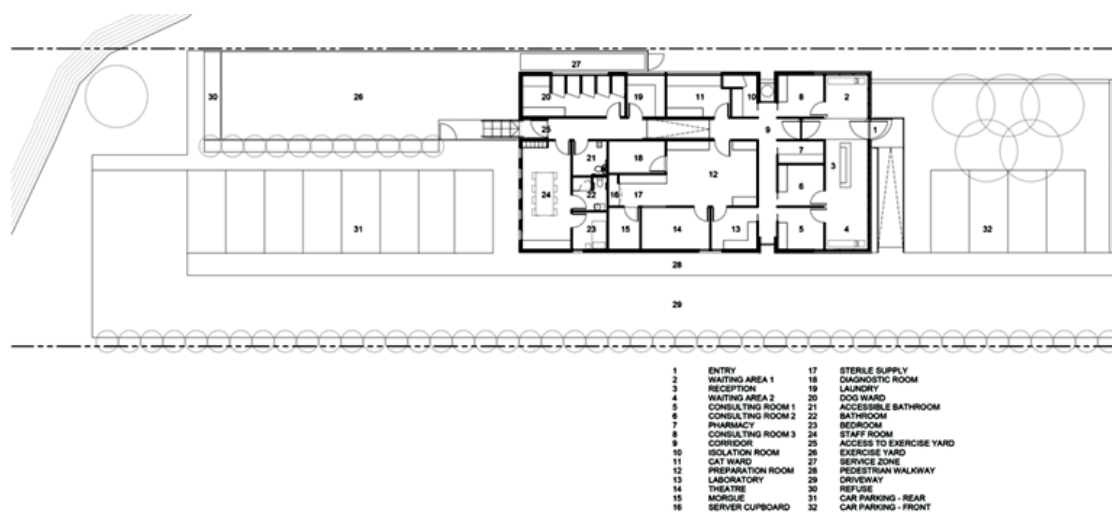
План 1-го этажа ветеринарной клиники Уоллан [6]
